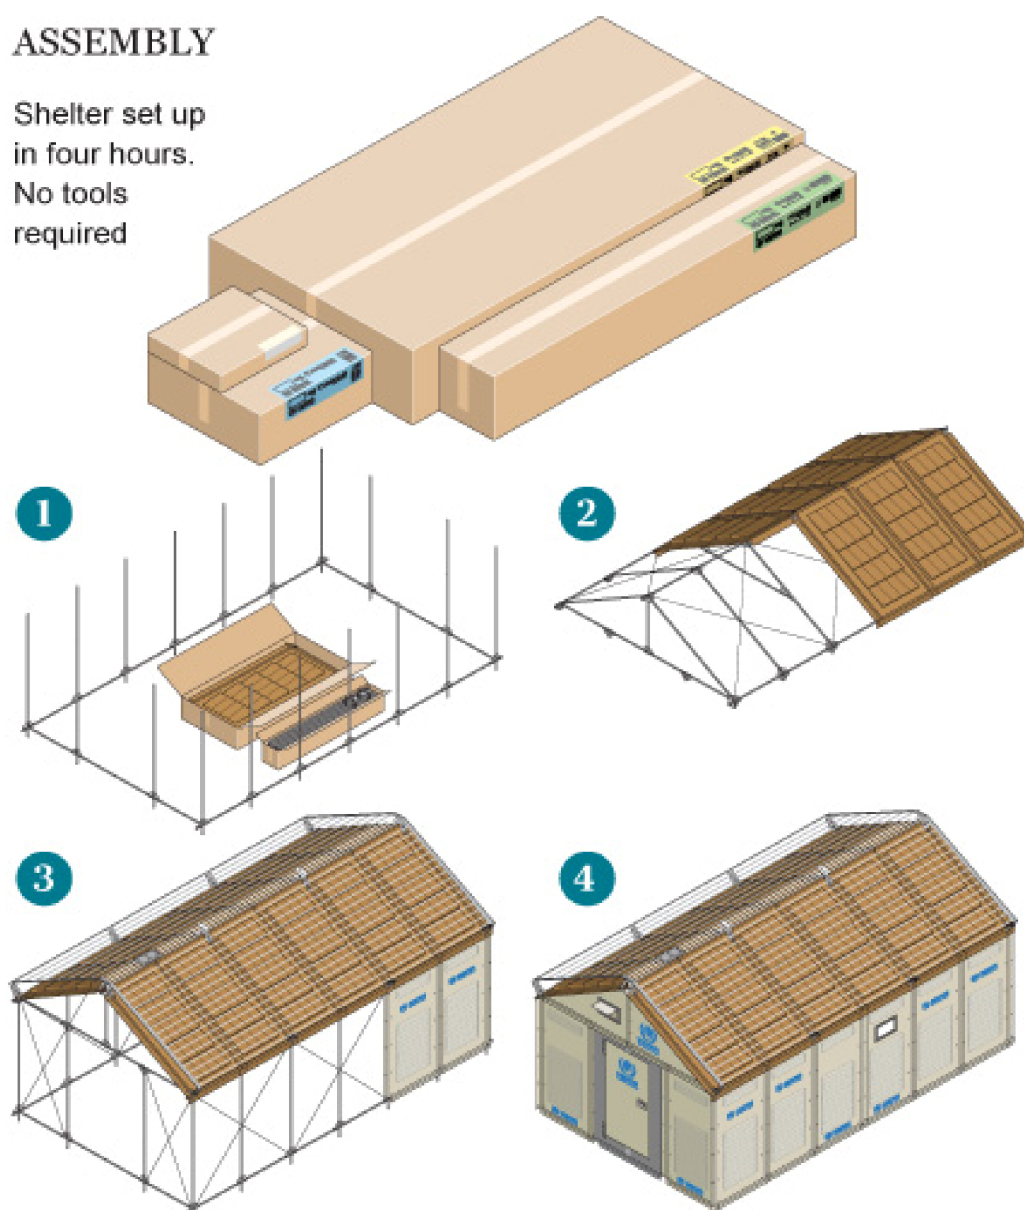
Exemplo do flat-pack-shelter do IKEA, gigante sueco do "ready-to-assemble".
